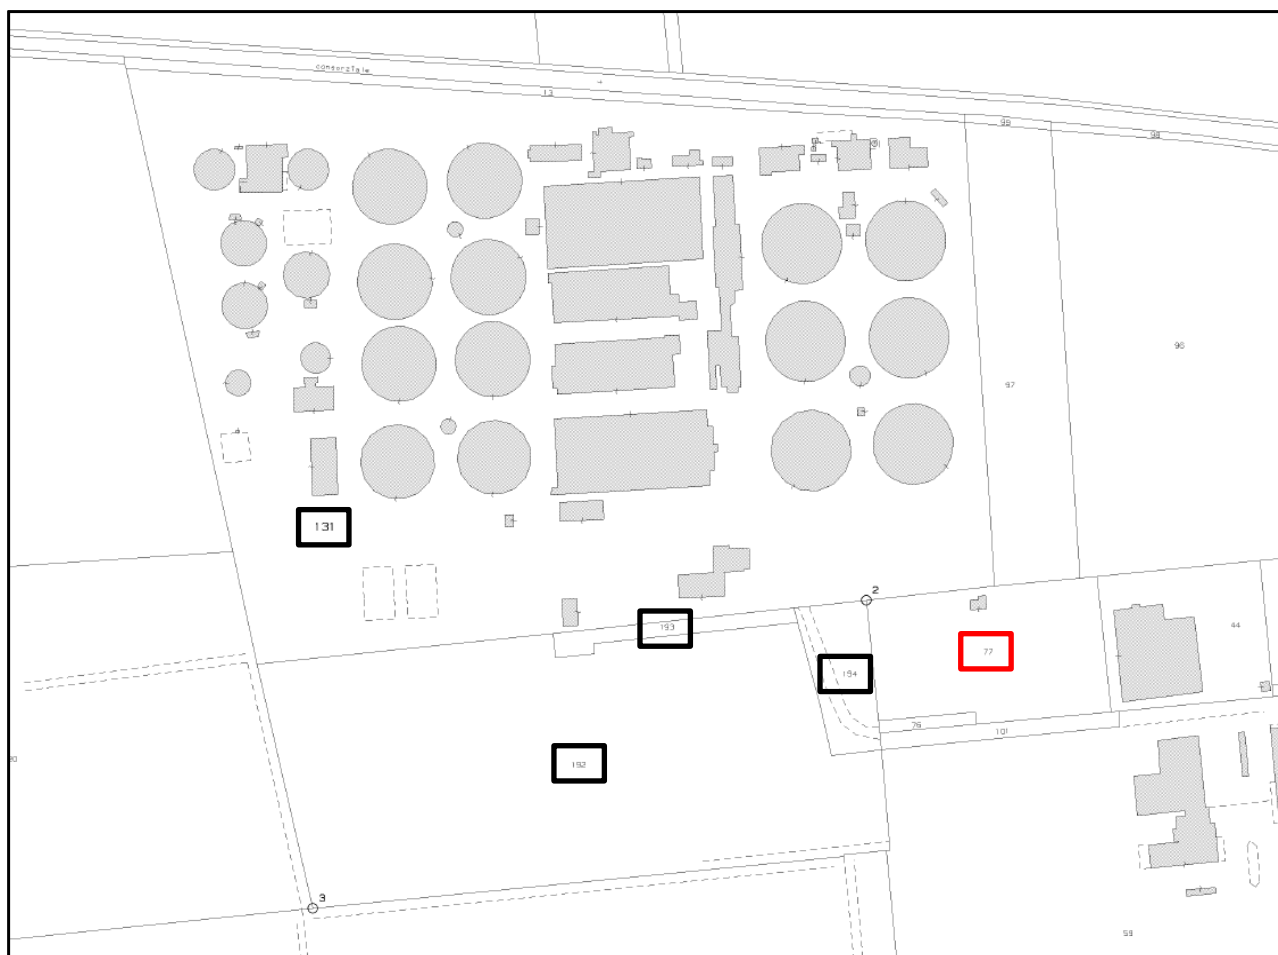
Planimetria catastale del depuratore e delle aree oggetto degli interventi di ampliamento
